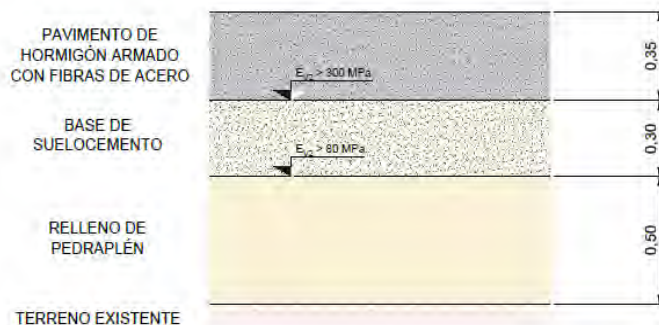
Propuesta de firmes de pavimento de hormigón armado con fibras metálicas para la nueva terminal de contenedores (Firme 1).
